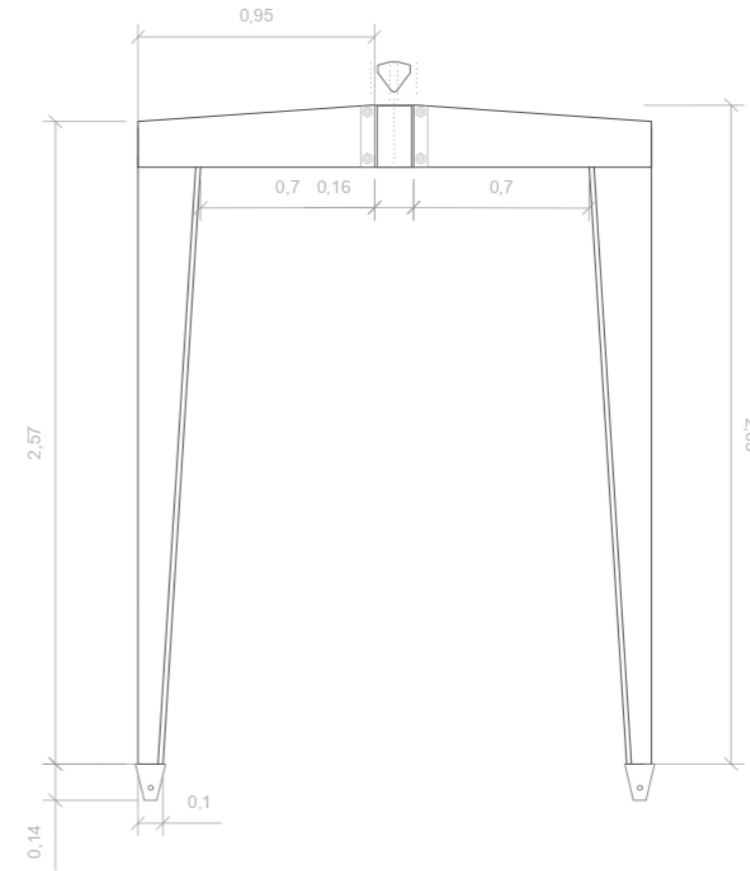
Detalle pórtico axial. E:1/25. Elaboración propia.
